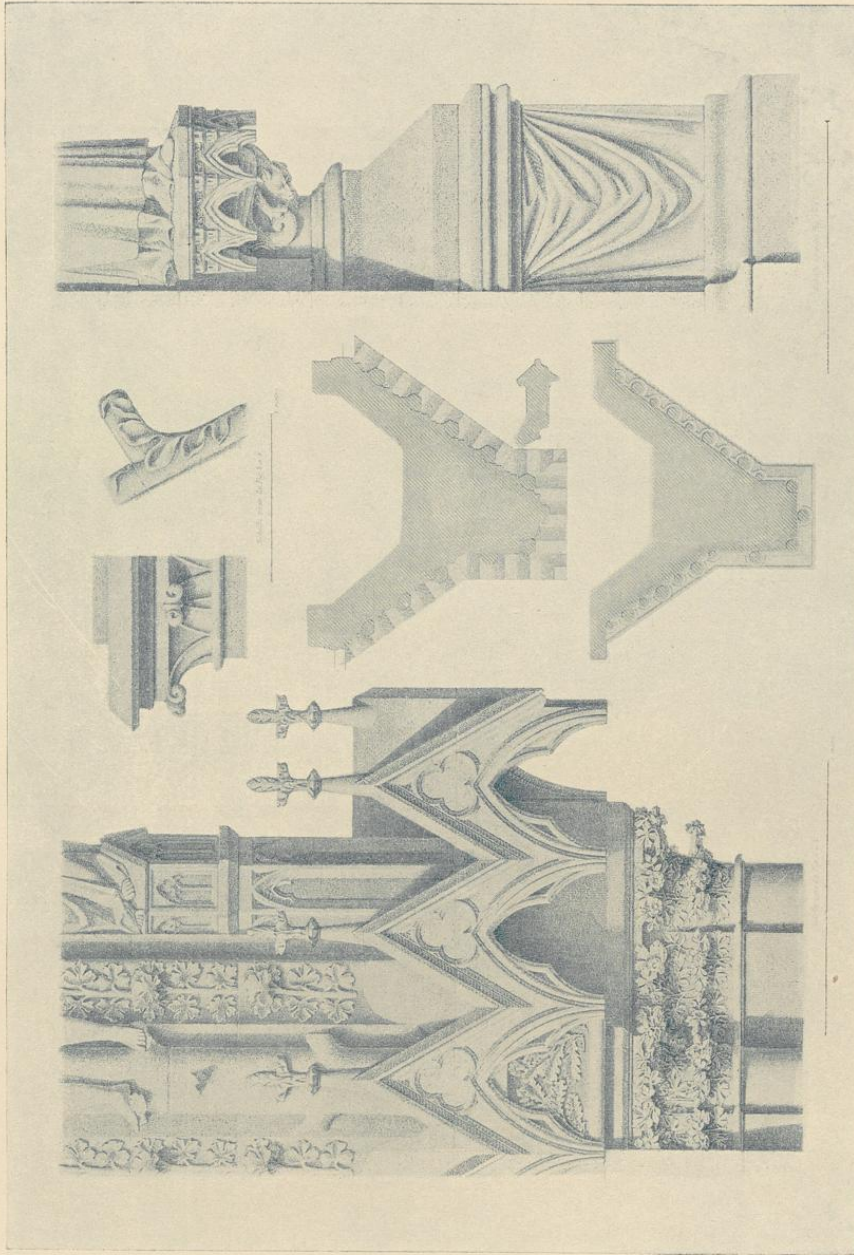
Kathedrale zu Reims. Façade. — Details der Vorhalle.
